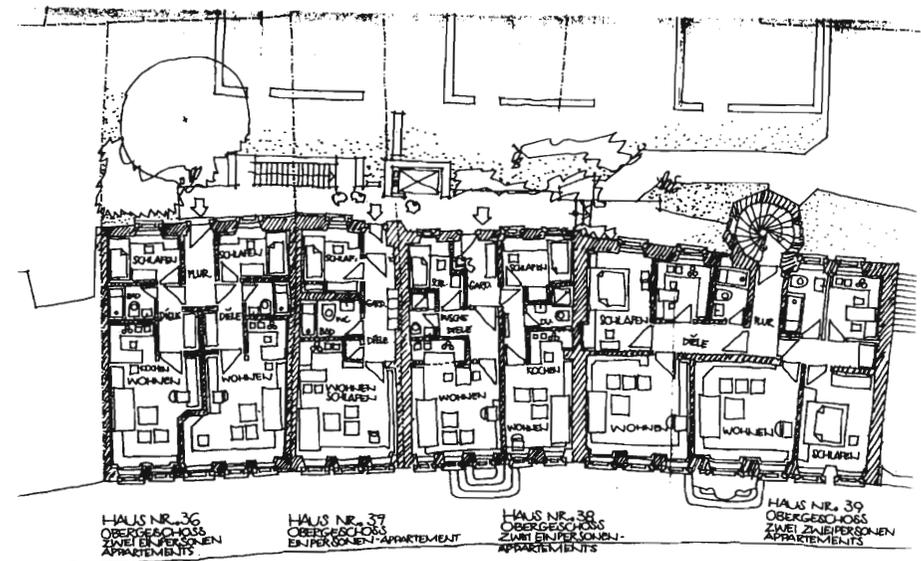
Krahenstraße: Vielfältig gestaltete Grundrisse sind in die unterschiedlichen Haustypen eingepaßt.
